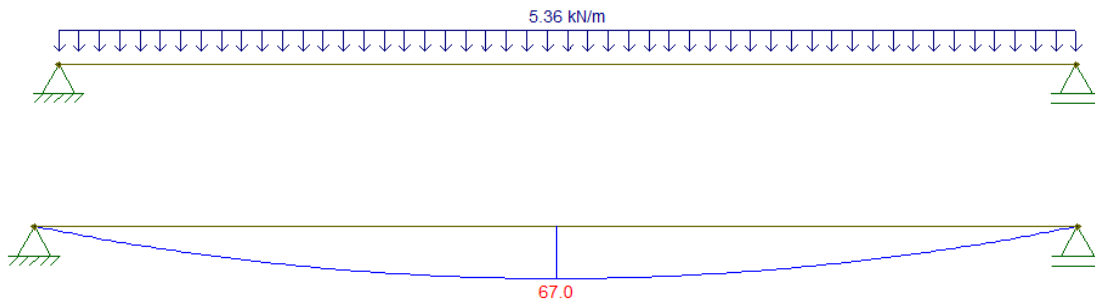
Modelo de cálculo para vigas bajo cubierta inaccesible laterales. Fuente: Elaboración propia
